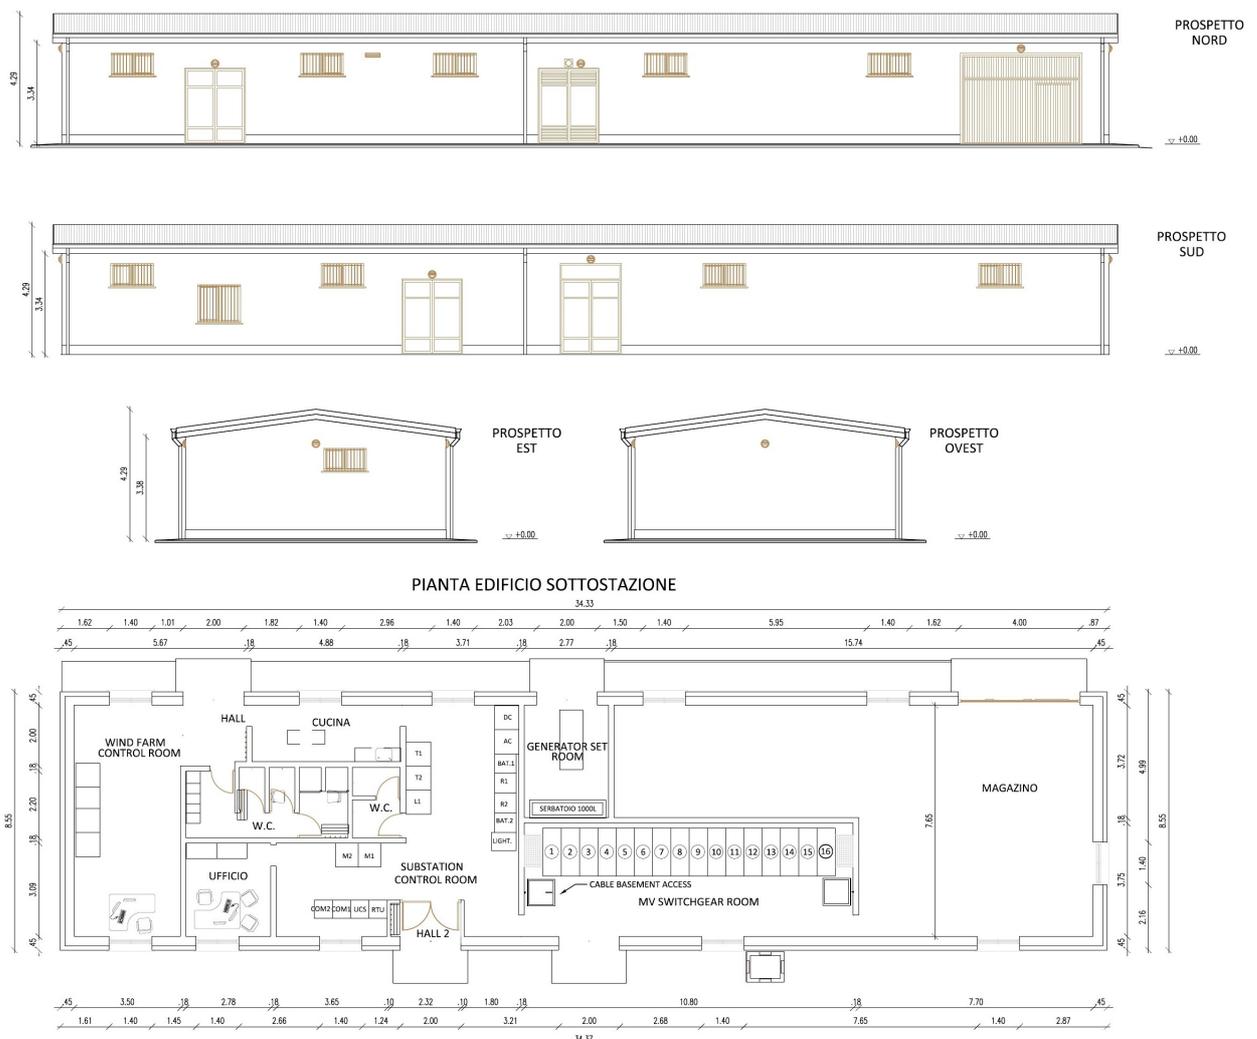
Pianta e Sezione dell'edificio della Stazione Utente
